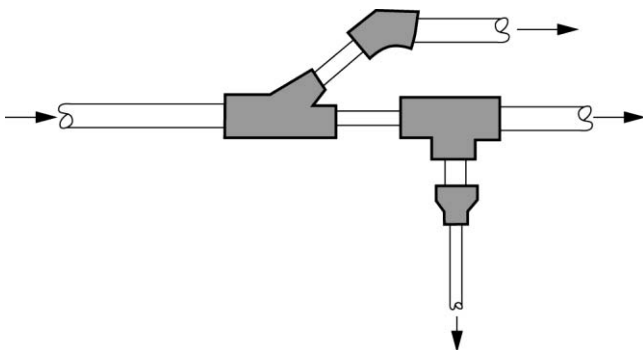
Фитинги позволяют вам менять размер и направление труб
